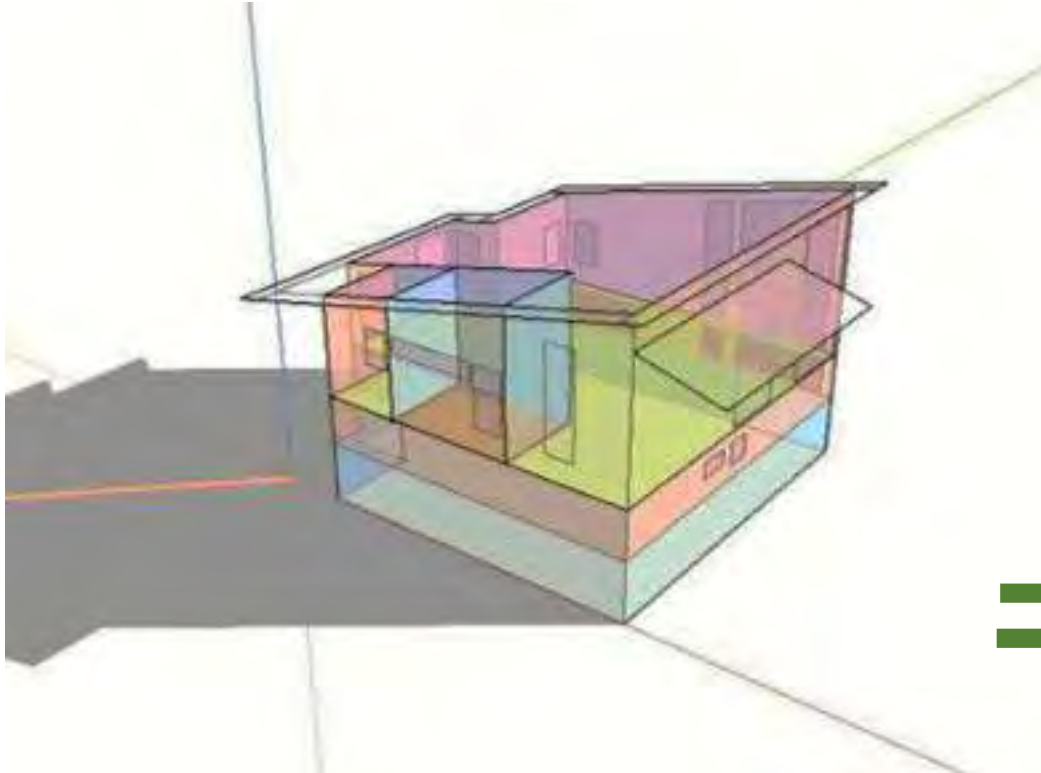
photomontage plans et photos du pavillon 32 L'Hermine
